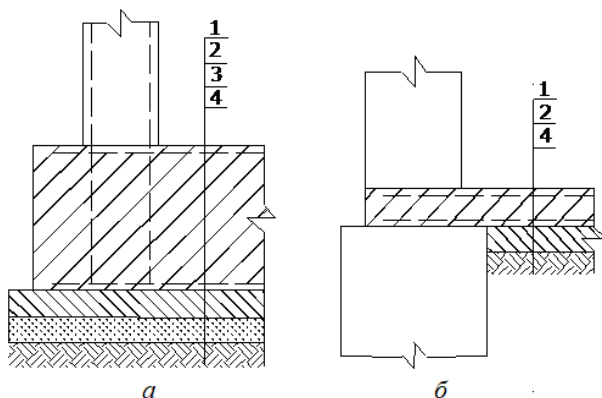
Конструкции барьеров: а — барьер в виде сплошной фундаментной плиты; б — барьер в виде сплошной плиты пола; 1 — монолитный железобетон; 2 — подготовка из тощего бетона; 3 — песчаная подсыпка; 4 — уплотненный грунт
